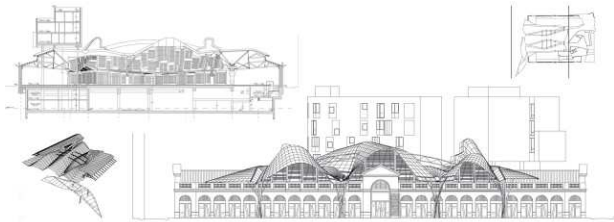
Estructuras Tomado de (onequalitythefinest el 15 de sep del 2014)
